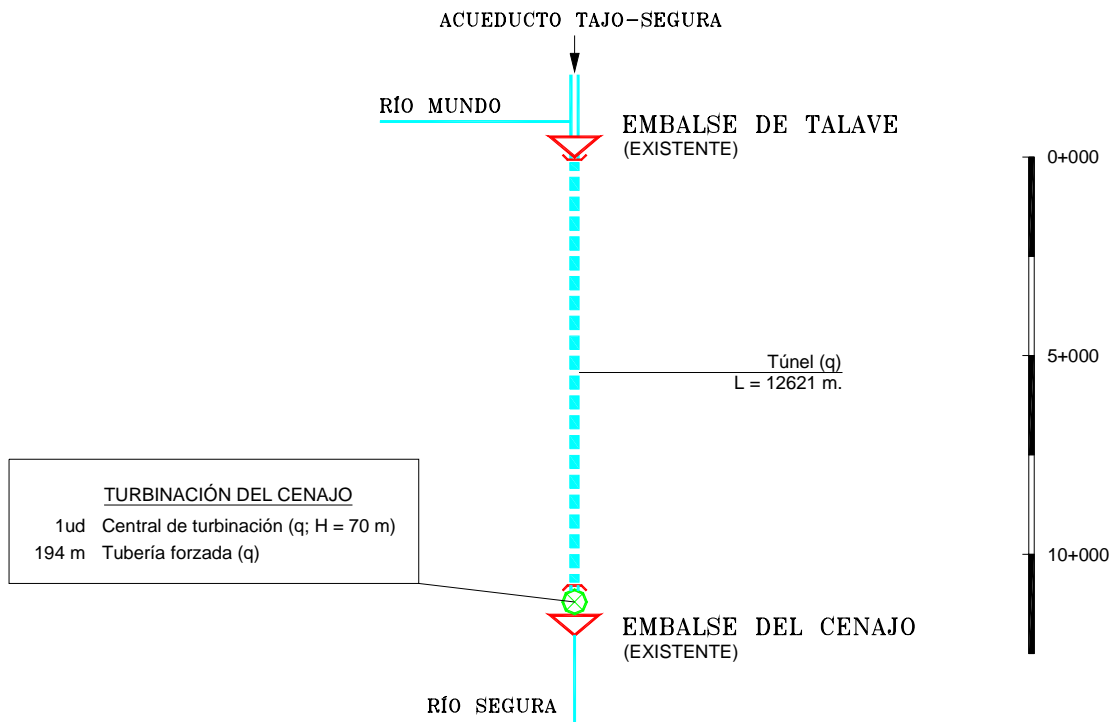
Conducción Talave-Cenajo. Esquema en planta
